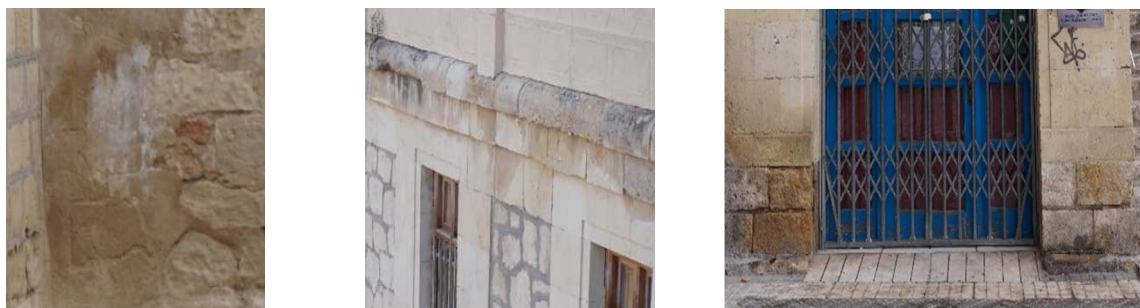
Imagen izquierda - Eflorescencia arranque del muro fachada lateral volumen 1. Imagen central - Eflorescencias en molduras. Imagen derecha - Eflorescencia en fachada principal. Fuente: Autora.
